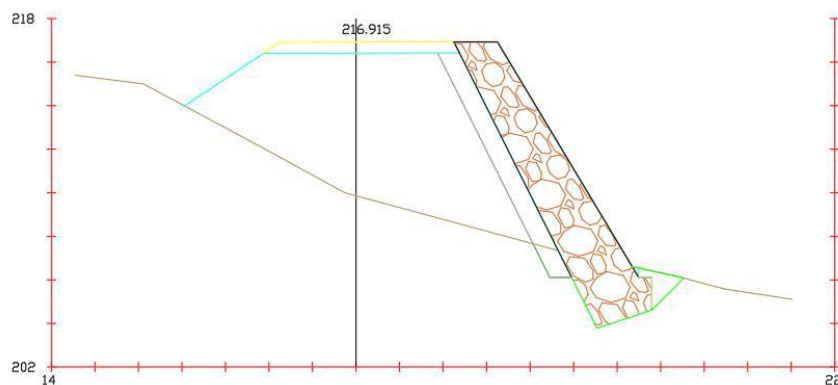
Tall transversal d'una secció del mur d'escullera de la BV-1212.
